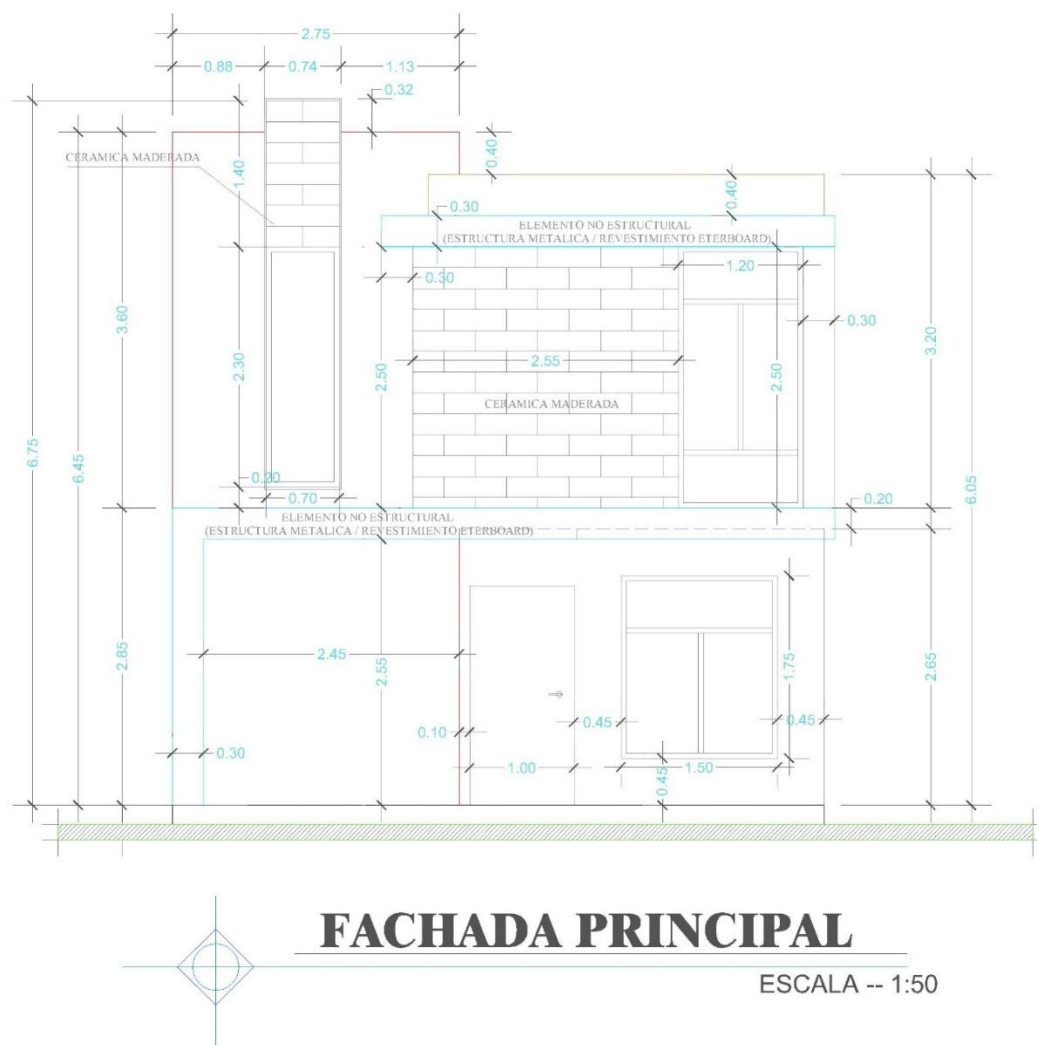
Planos arquitectónicos vivienda de hormigón armadoNota. Proporcionado por arquitecto de la vivienda.
